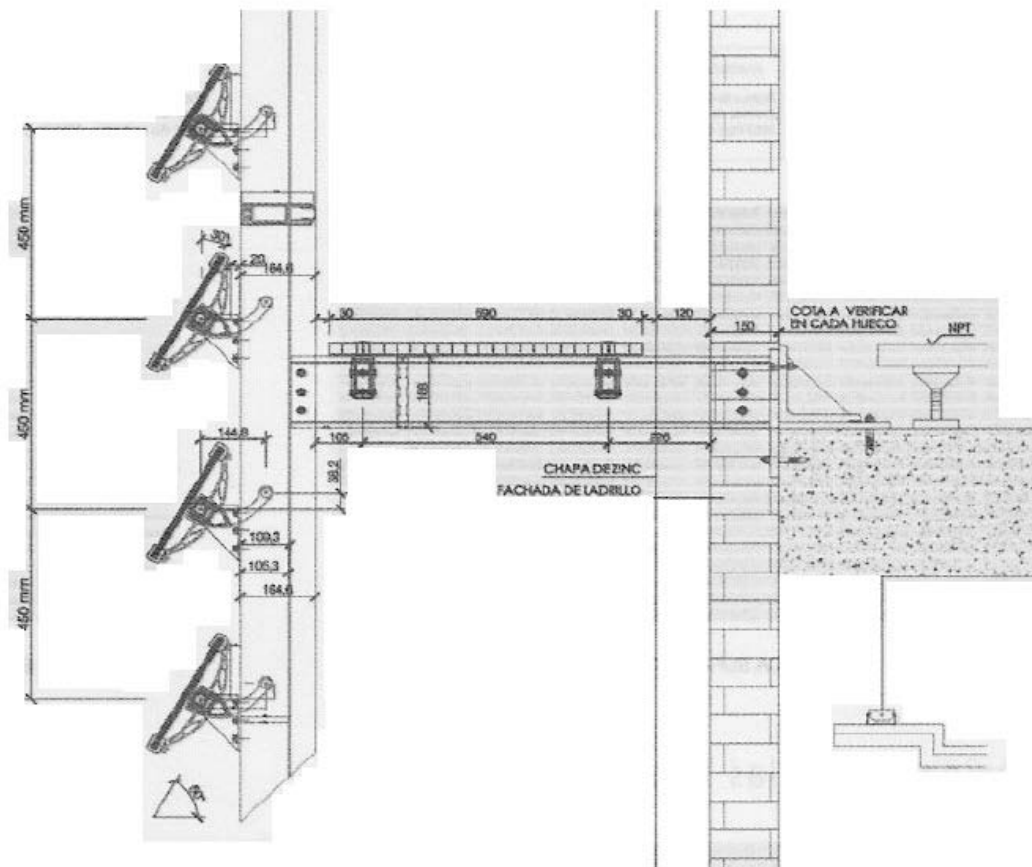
Detalle de sección transversal de fachada. Fuente: Guía Integración Fotovoltaica comunidad de Madrid
